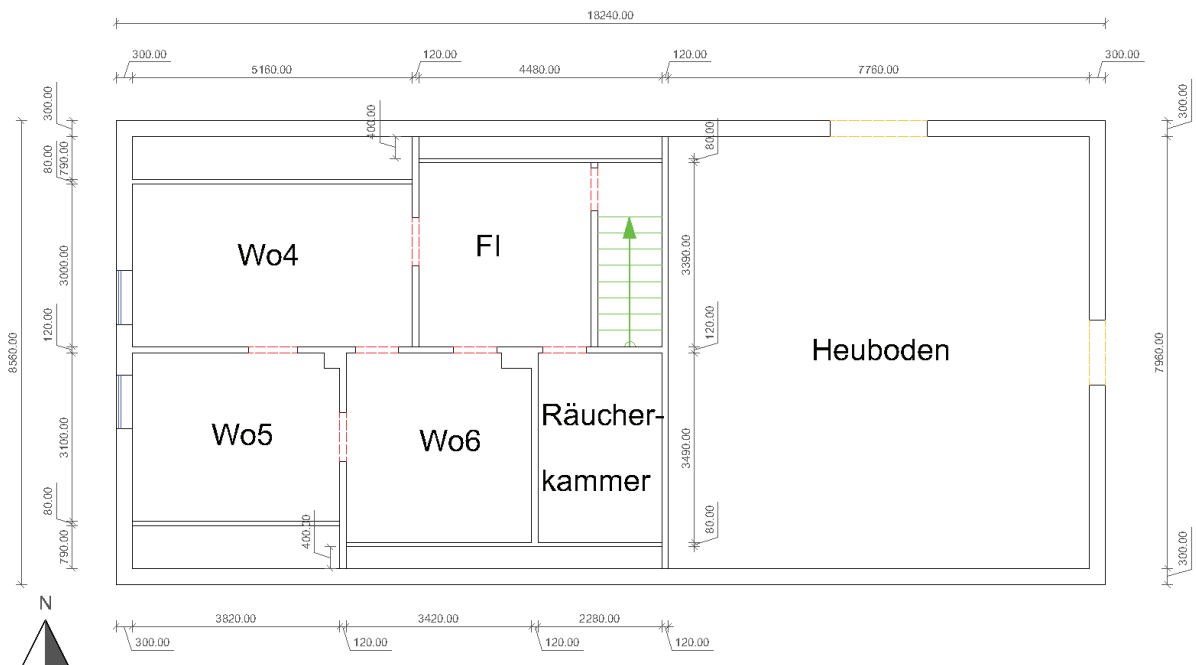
Grundriss Dachgeschoss 1938. Ein Original lag nicht vor, weshalb dieser Grundriss auf der Grundlage des Grundrisses von 1978 rekonstruiert wurde. Digitalisiert von Rostek (2023).
